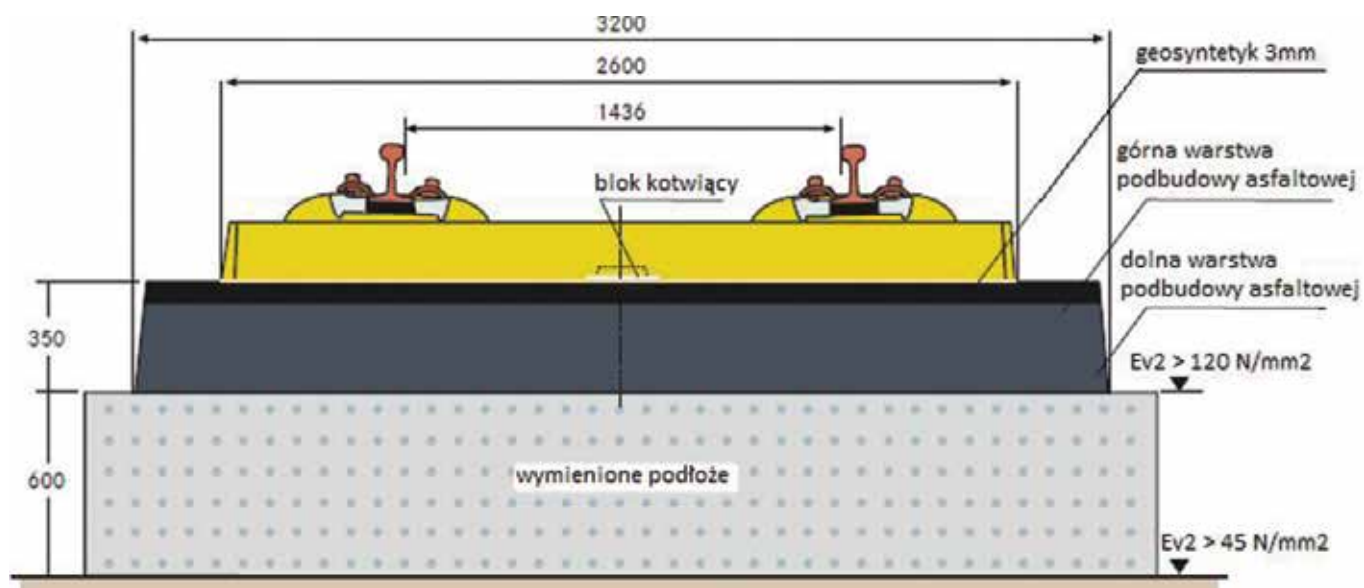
Konstrukcja nawierzchni typu ERS [6]
